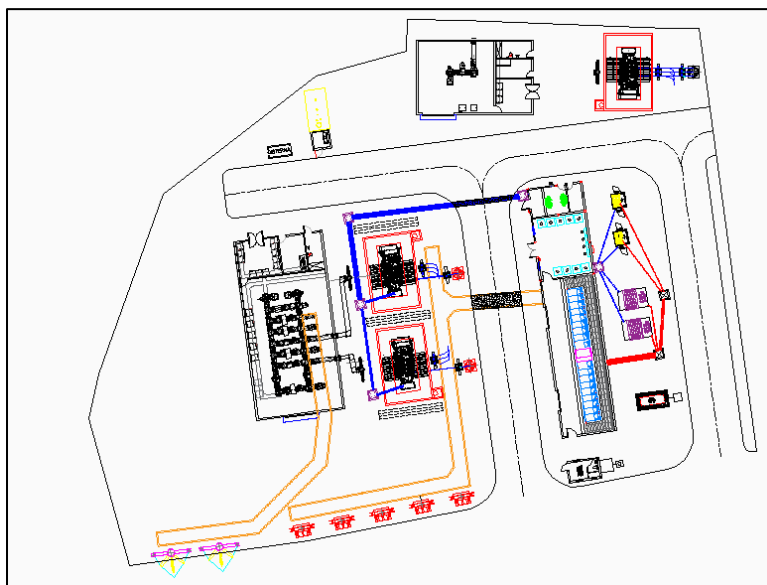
Edificación proyectada que será levantada en la zona de estudio. Tomada del plano arquitectónico del proyecto.
